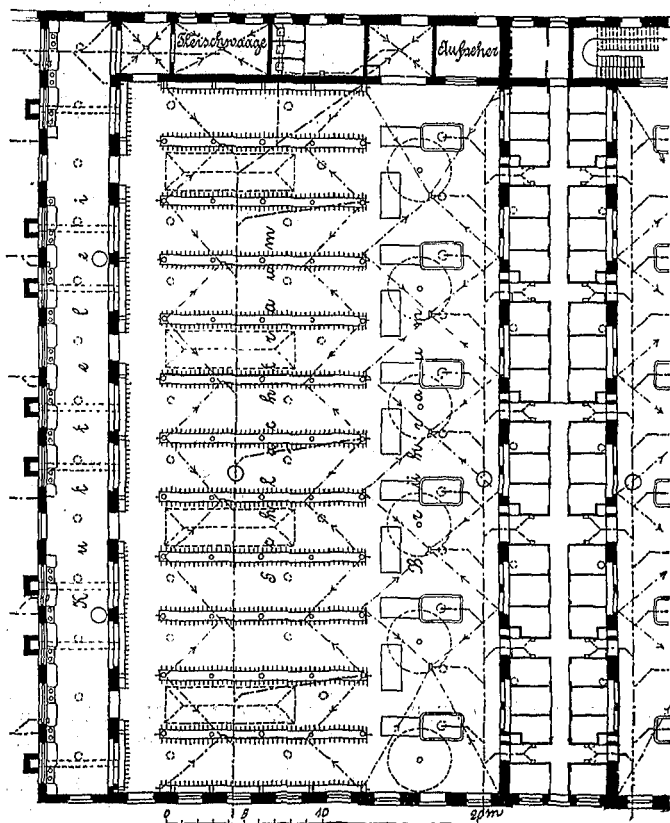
Schweine-Schlachthalle. Halber Grundriss.
